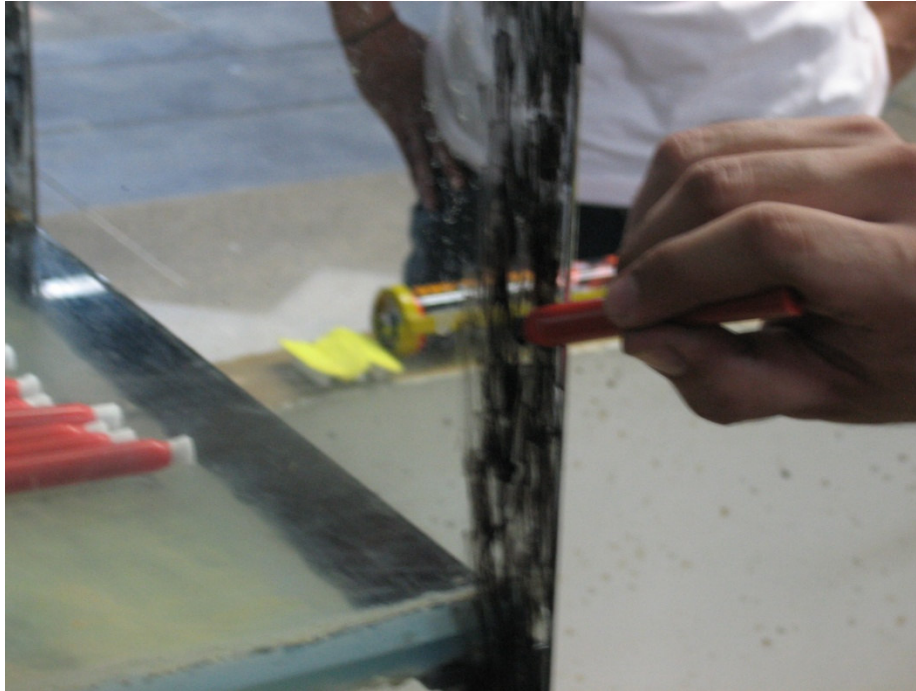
Instalación de perfiles. Preparación superficie vidrio.
